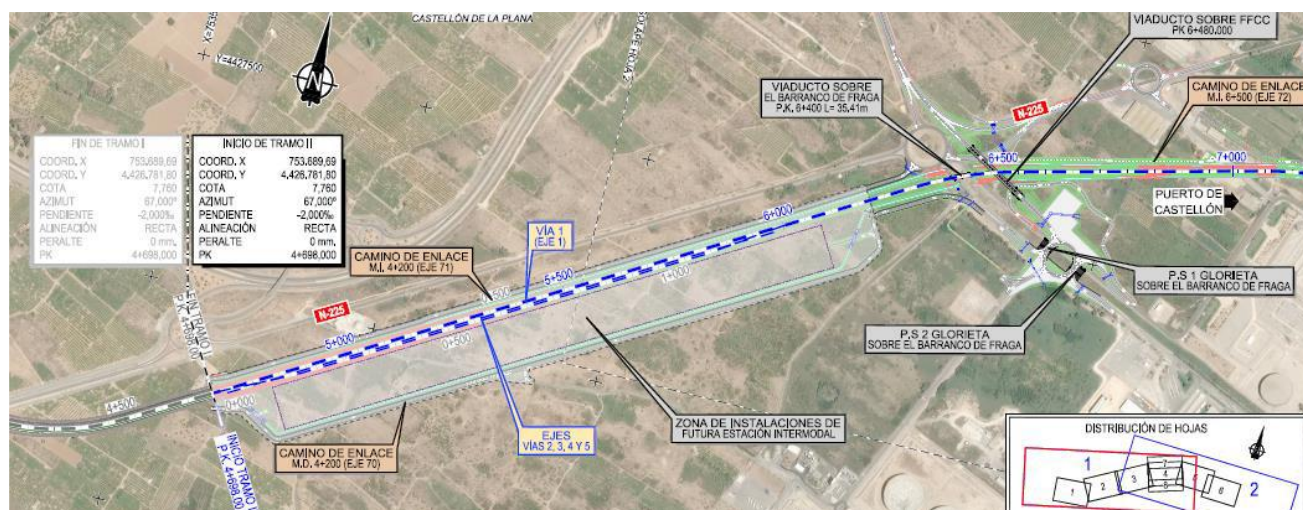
Detalle plano de conjunto del pr. constructivo de plataforma del nuevo acceso ferroviario sur al puerto de Castelló. Tramo II (INECO)
